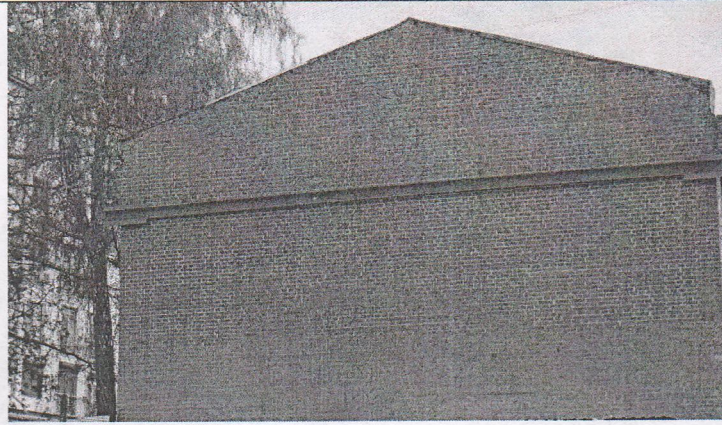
Фрагмент брандмауэрной стены со стороны западного фасада.
